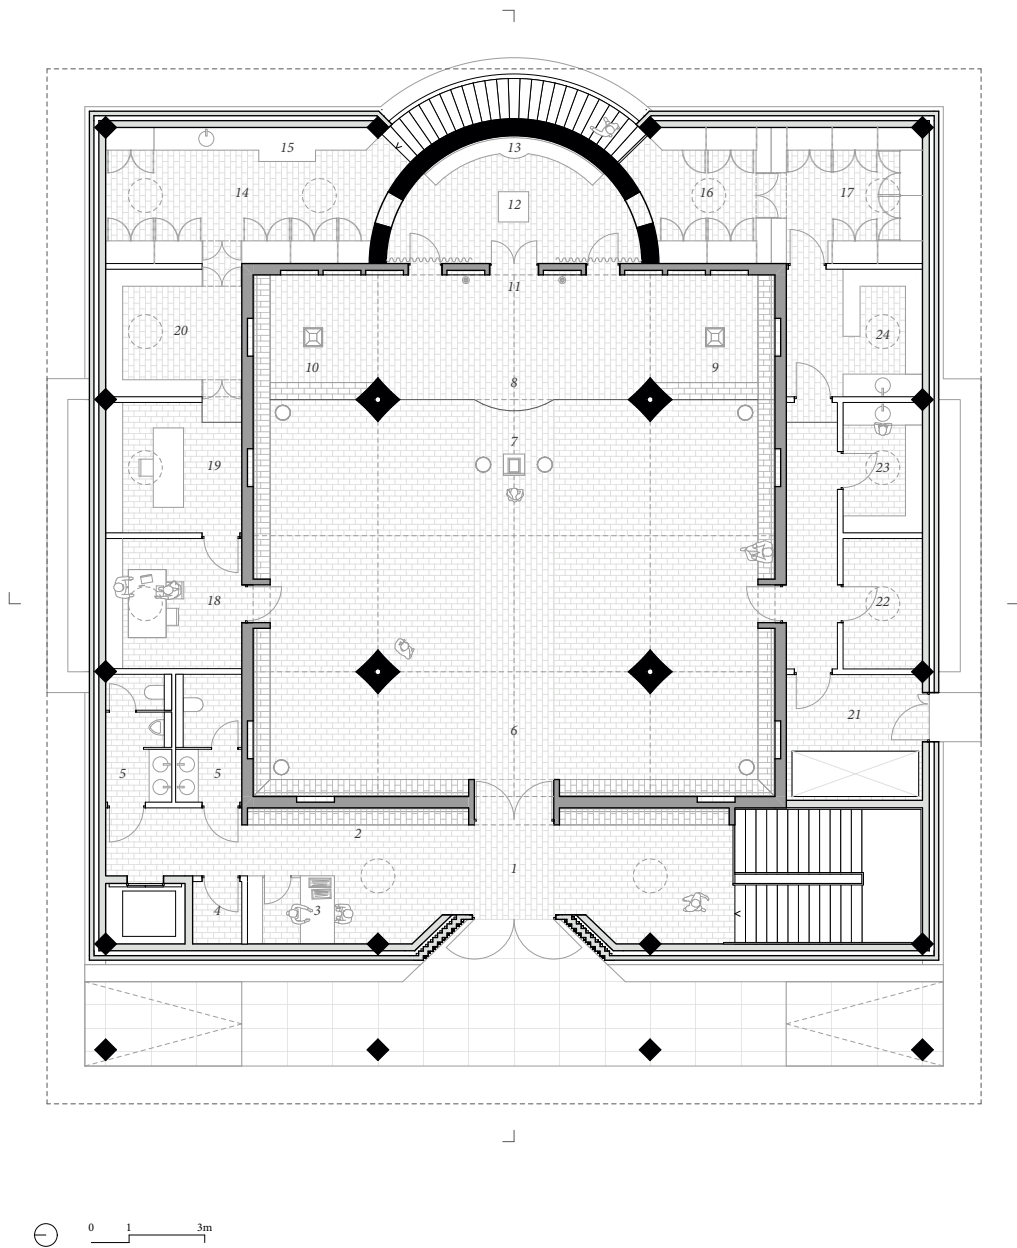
Grundriss Erdgeschoss, M 1:200
